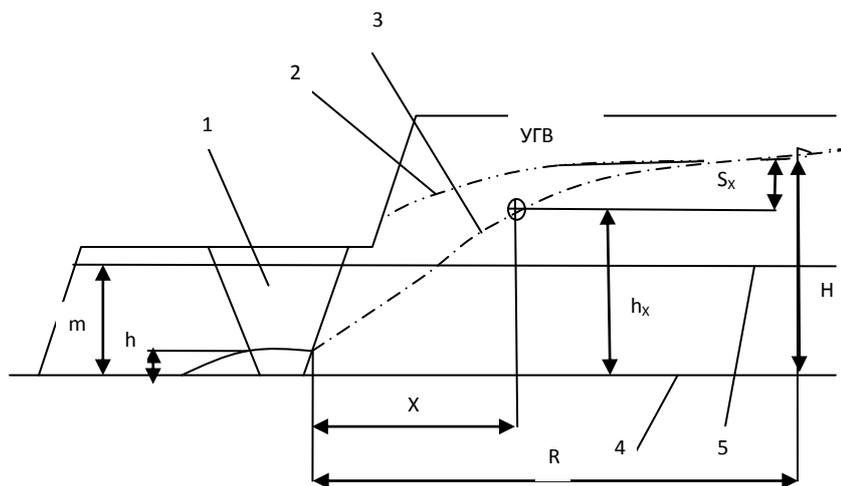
Схема осушения дренажной траншеей: 1 - опережающая дренажная траншея; 2,3 - депрессионные кривые до и после осушения; 4- подошва водоносного пласта; 5 - кровля водоносного пласта в напорных условиях
